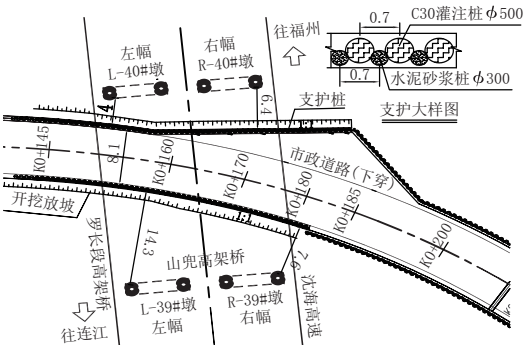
道路下穿沈海高速山兜高架桥平面图(单位:m)
